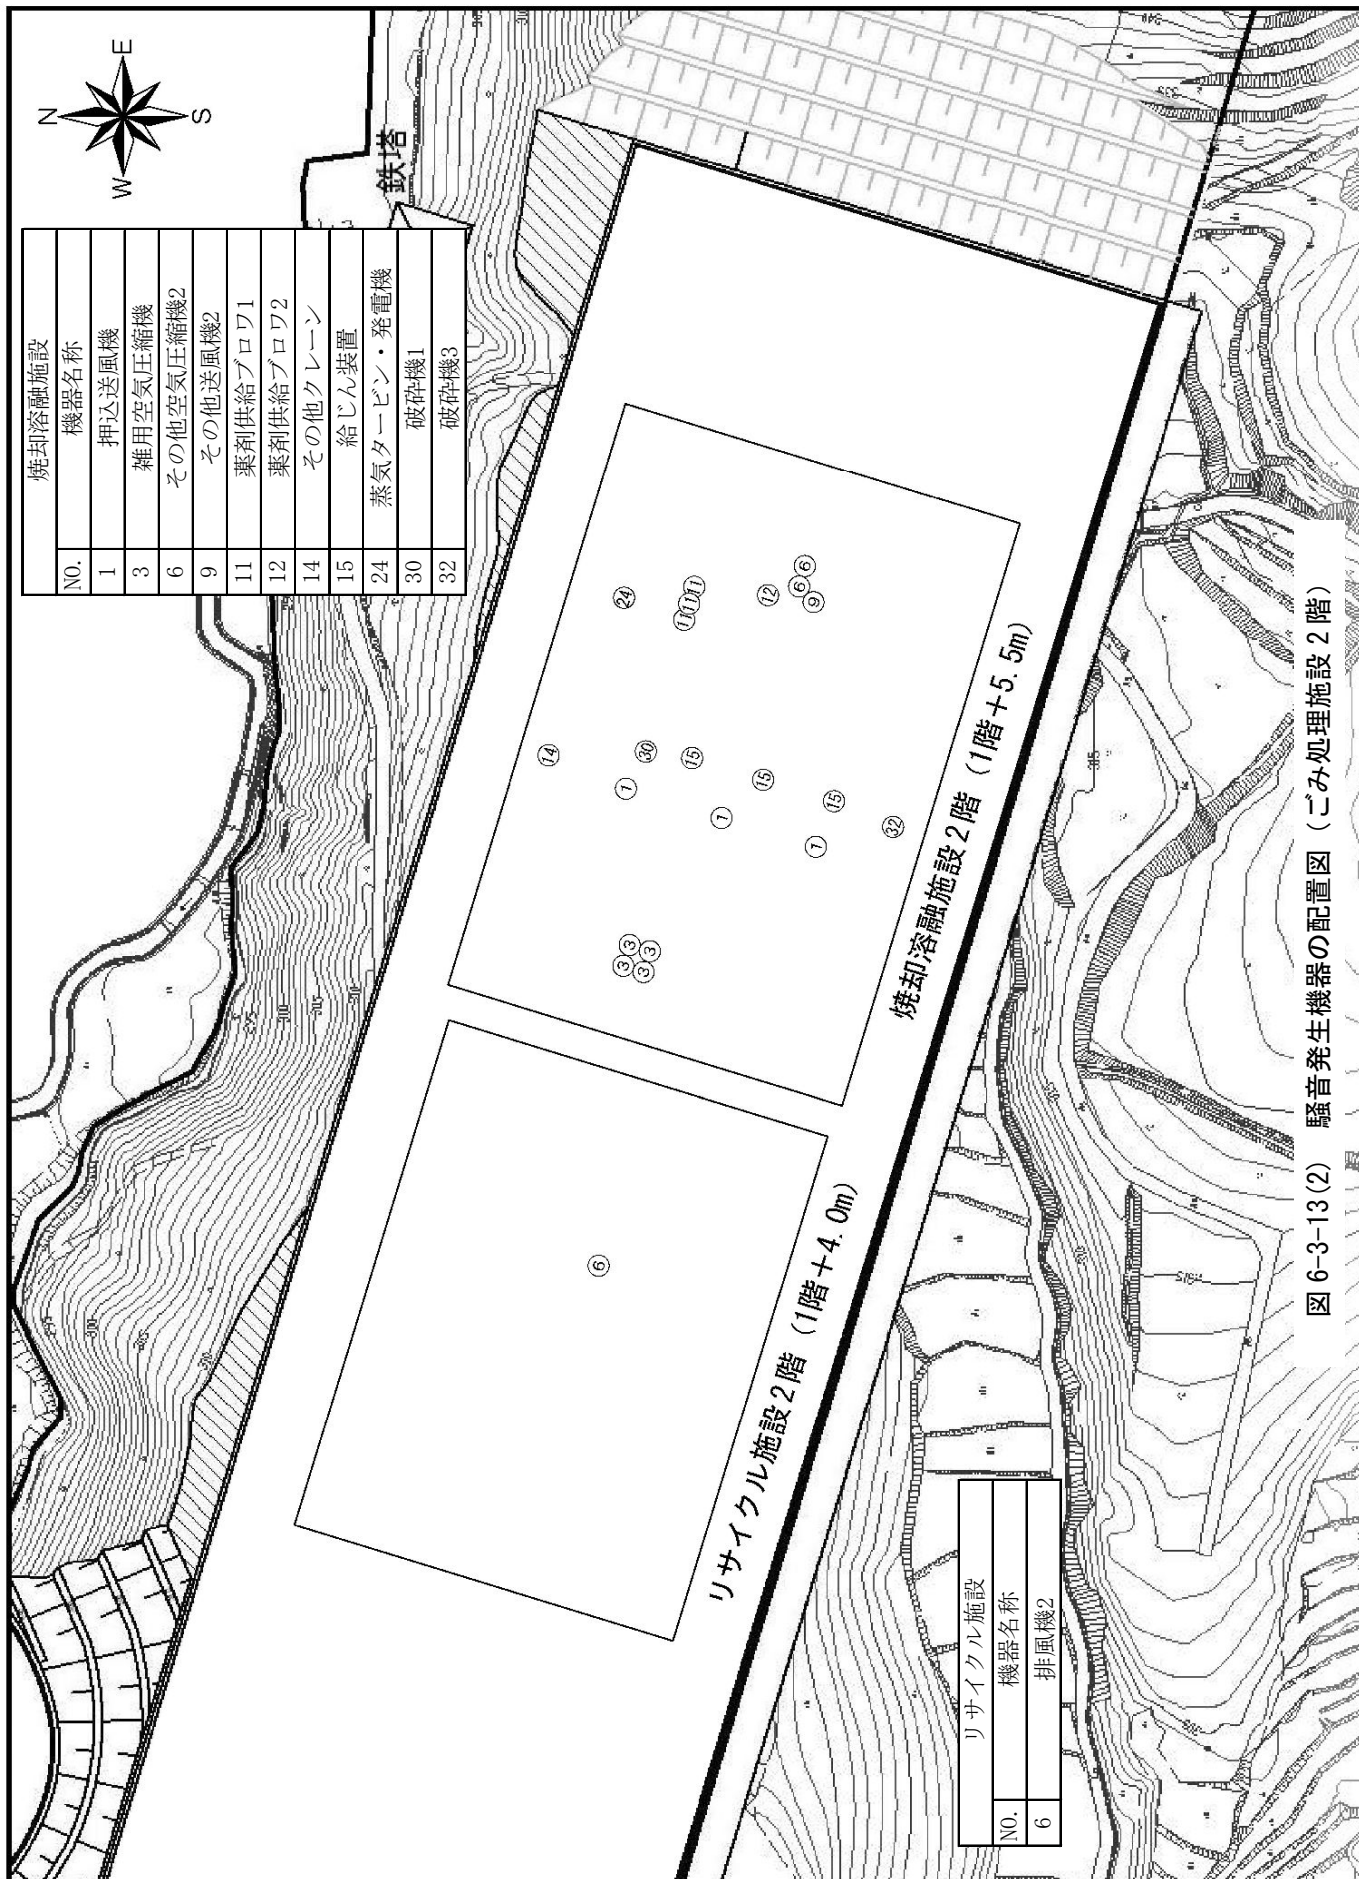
(2) 騒音発生機器の配置図 (ごみ処理施設 2階)
